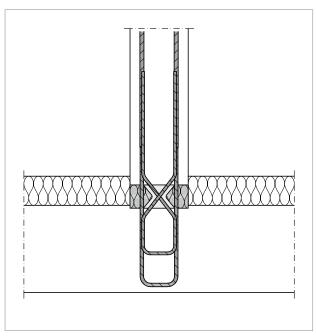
Schöck Sconnex® Typ W Sonderzugelement: Schnitt E-E; Aufhängung der Decke an eine Wand
